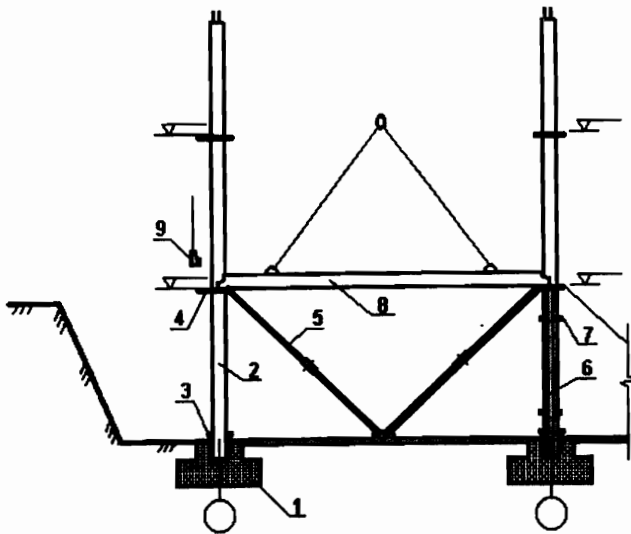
Технологические схемы установки, выверки и временного крепления элементов каркаса подземной части здания: 1 – фундаменты стаканного типа; 2-3-х ярусные колонны; 3 – клиновый вкладыш для временного крепления колонн и выверки в проектное положение; 4 – металлический воротник; 5 – подкос с регулируемой длиной; 6 – панель диафрагмы; 7 – фиксатор; 8 – монтируемая панель перекрытия; 9 – бортовая балка в процессе монтажа
